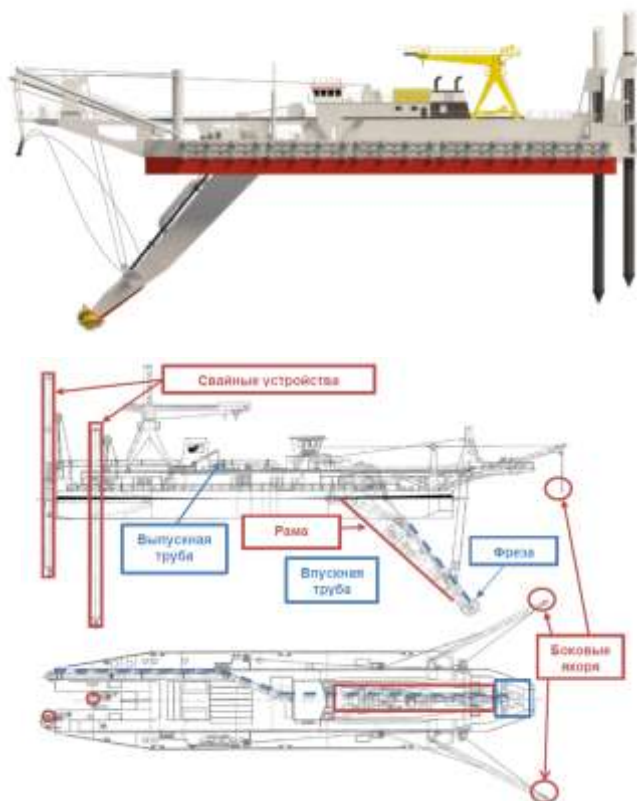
Фрезерный земснаряд, вид сбоку и сверху
